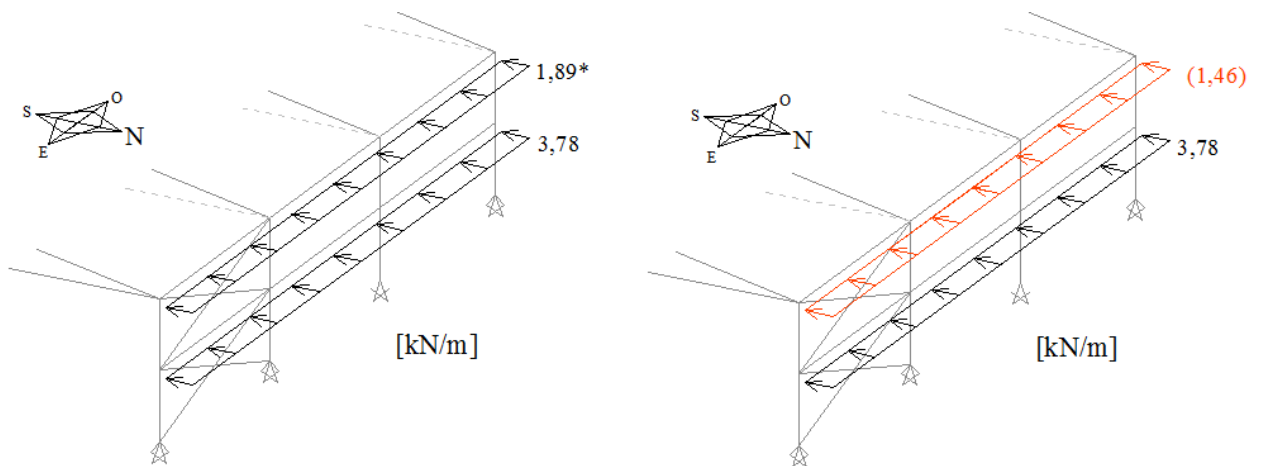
Vento W1 na fachada orientada a Norte na situação 2 (RSA)
